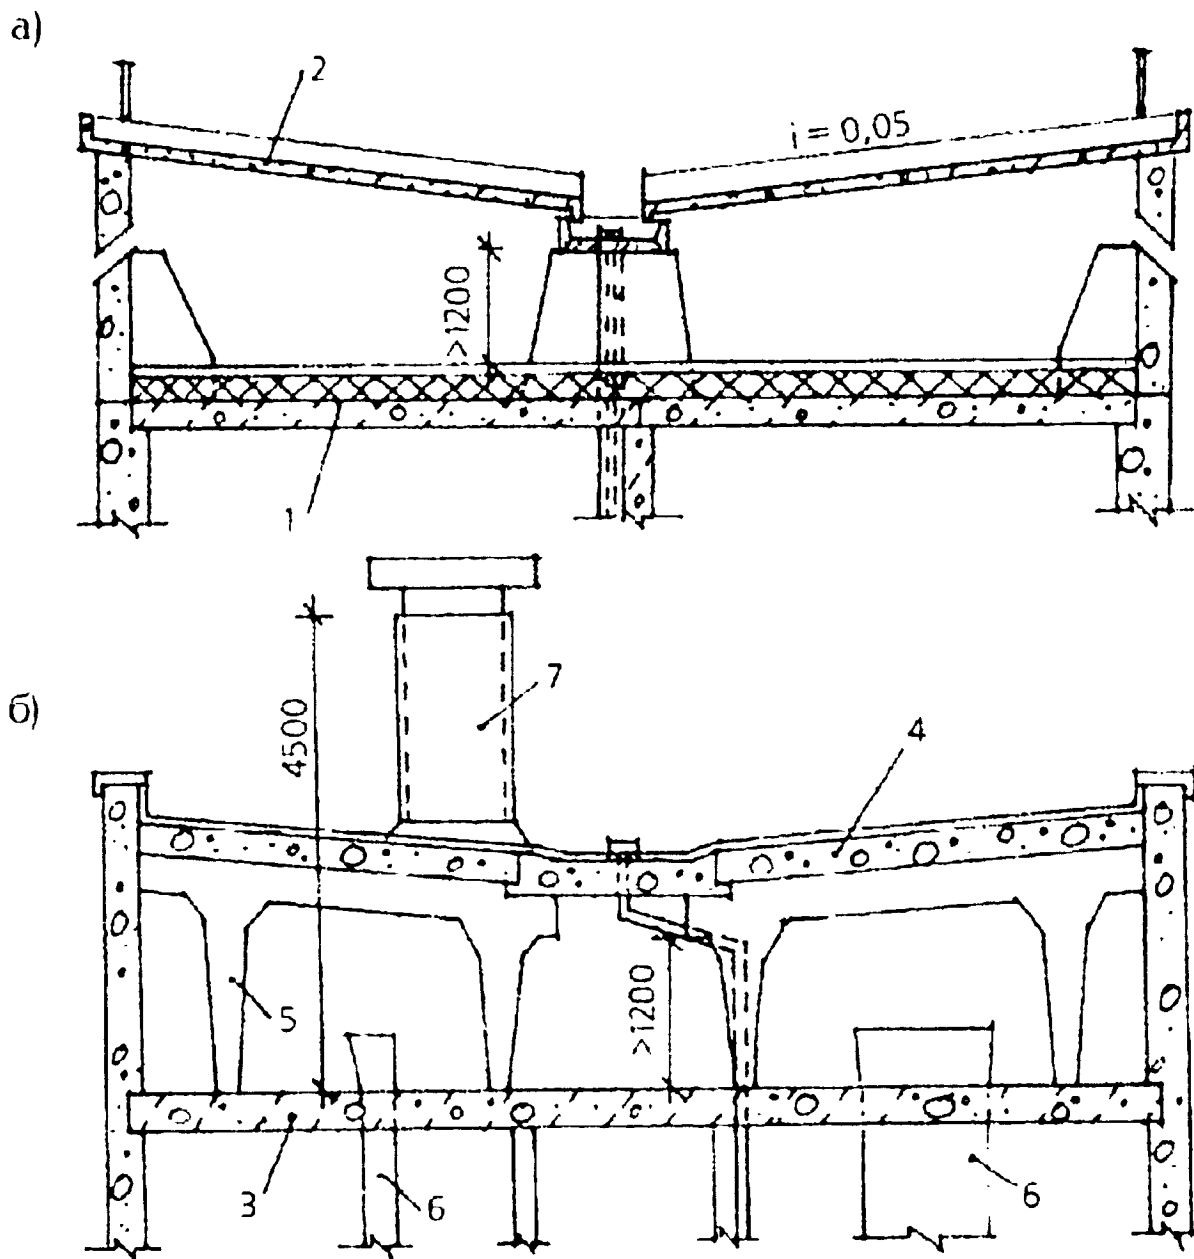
Индустриальные типы чердачных крыш: а - с холодным чердаком; б - с вентилируемым чердаком; 1 - утепленное чердачное перекрытие; 2 - железобетонные кровельные панели; 3 - железобетонная плита перекрытия; 4 - легкобетонные кровельные панели; 5 - легкобетонный каркас; 6 - оголовок вент блока; 7 - вытяжная вентиляционная шахта
